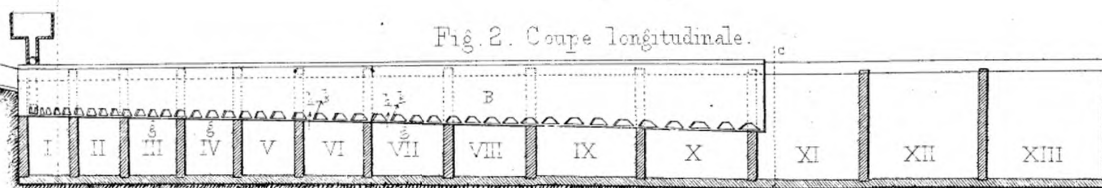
Lavoir à Schlamms de la Mallesue Coupe longitudinale.
